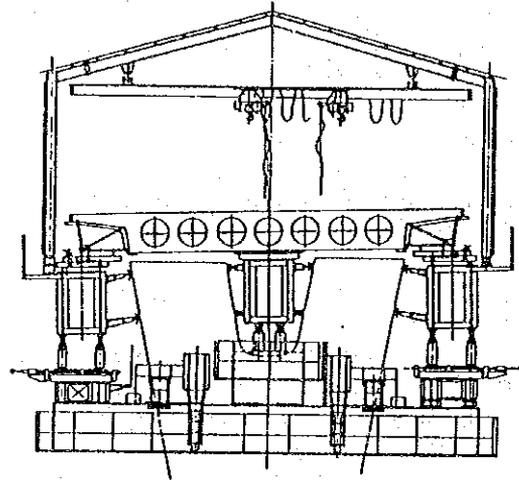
Método de Construcción de la Superestructura Mediante Andamiaje Móvil
